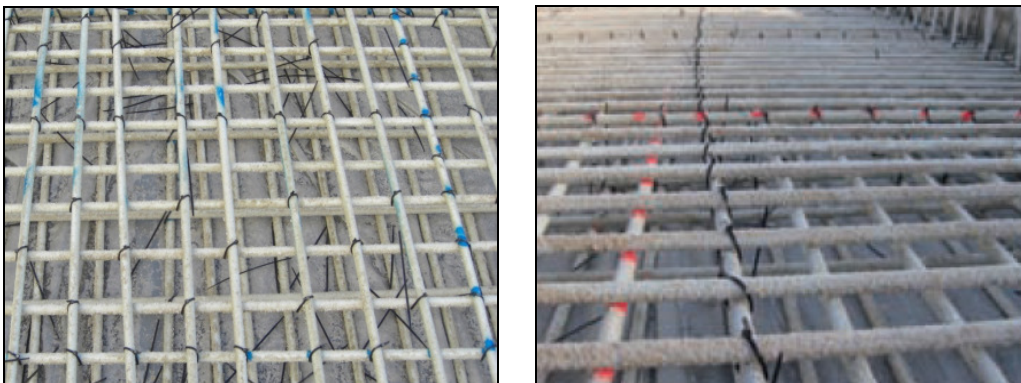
Armado colocado y sujeto para quedar inmovilizado durante el hormigonado.
